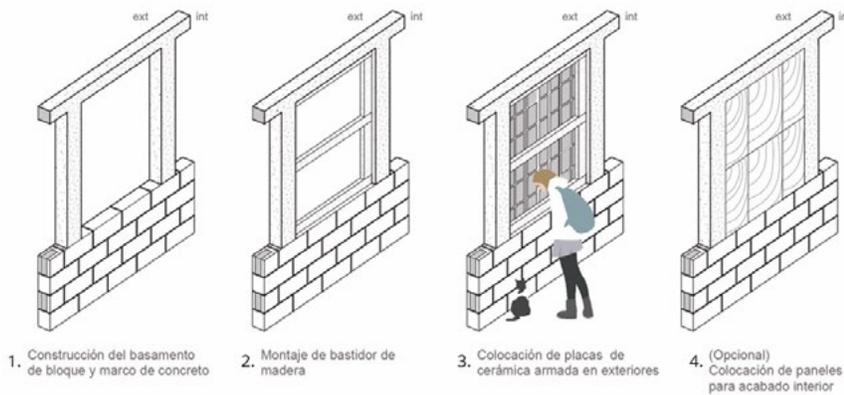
Montaje de las placas prefabricadas sobre zócalo de bloque de concreto y marco de hormigón armado embebido en el mismo (fuente: Elaboración propia, 2018).
